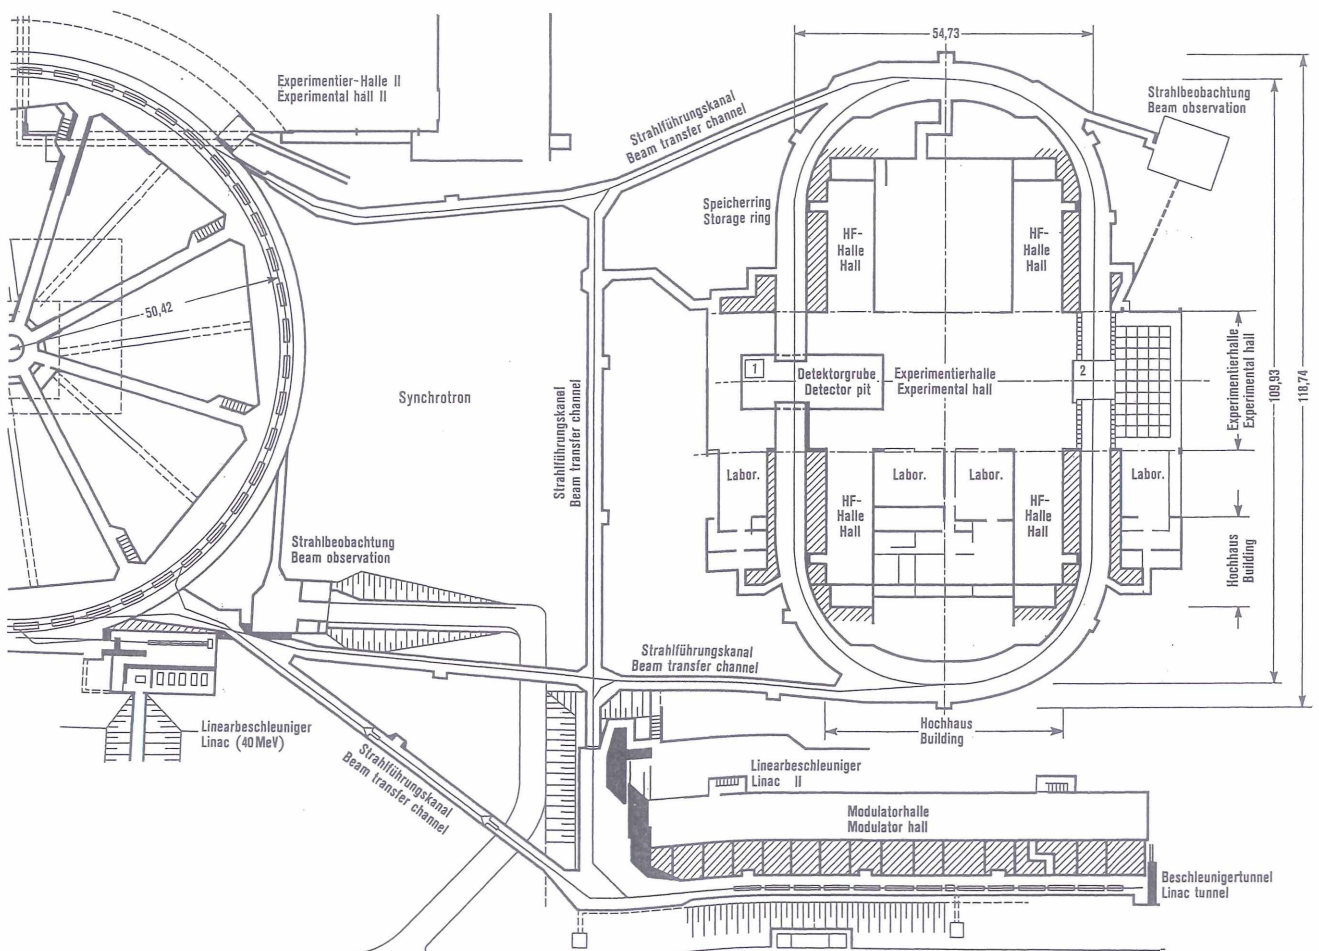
Lageplan mit Grundriß des Speicherringgebäudes und Einschubwegen
